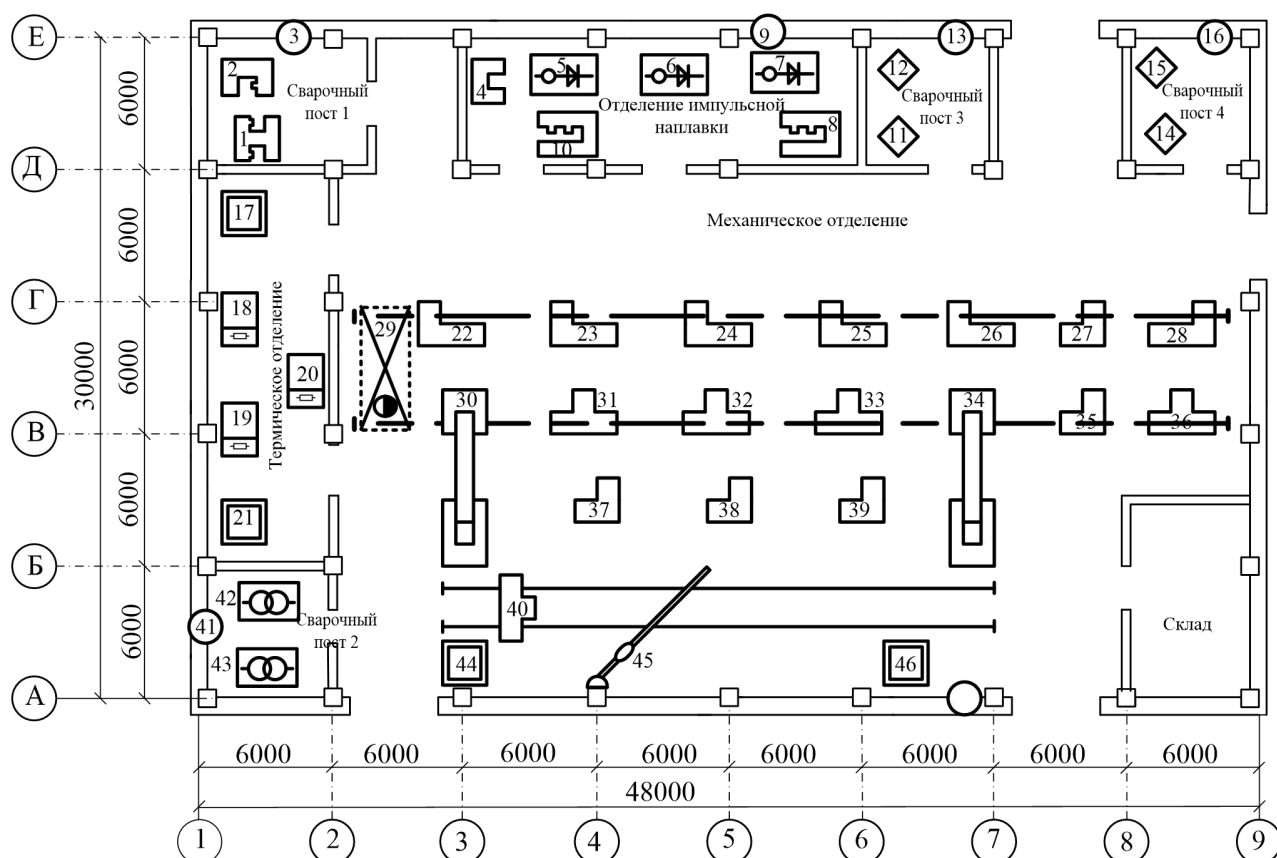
План расстановки электрооборудования сварочного цеха. Цех 8
